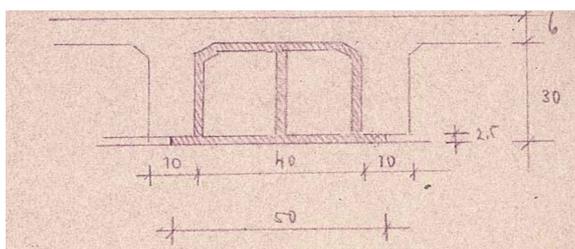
Querschnitt der Tragrippe einer Stahlbetondecke gemäß ursprünglicher Planunterlagen
